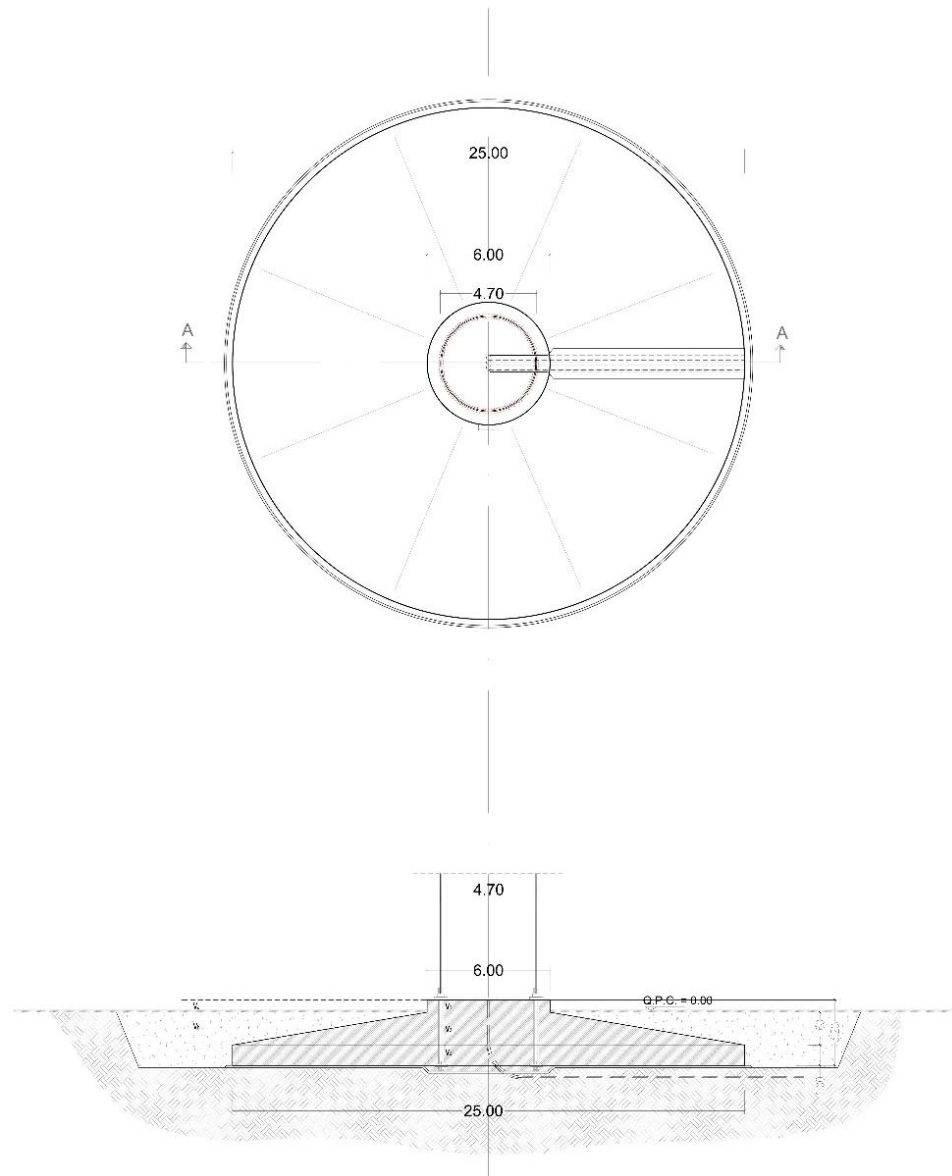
Pianta e vista della fondazione tipo dell'aerogeneratore
